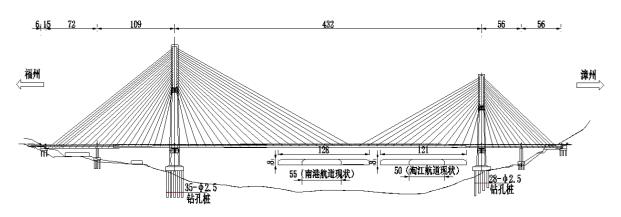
乌龙江特大桥桥桥式布置图 (单位: m)
